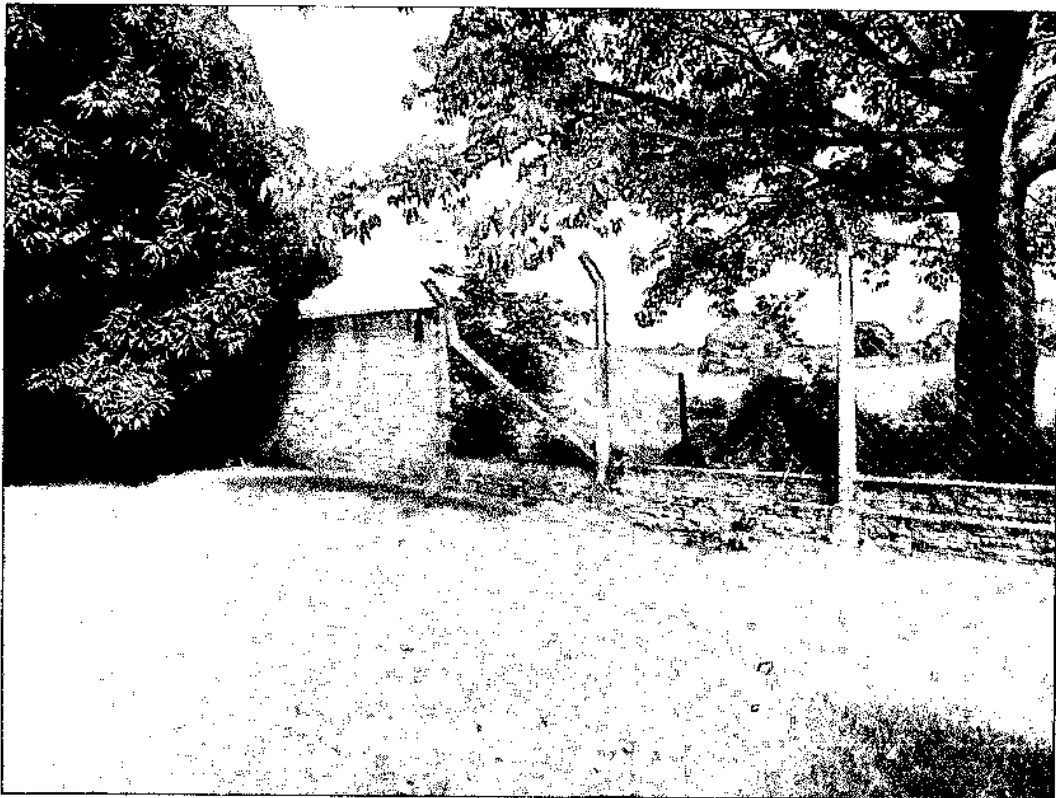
DETALHE DO FECHAMENTO DA SEDE – MUROS E ALAMBRADOS
